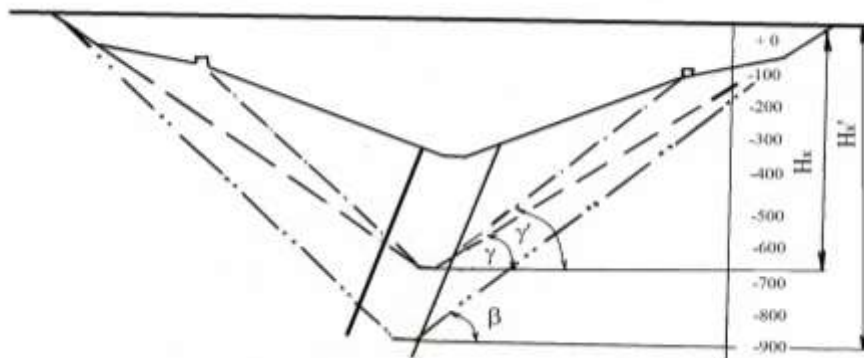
Развитие горных работ при отработке крутопадающего пласта с разными углами откоса нерабочего борта карьера.
